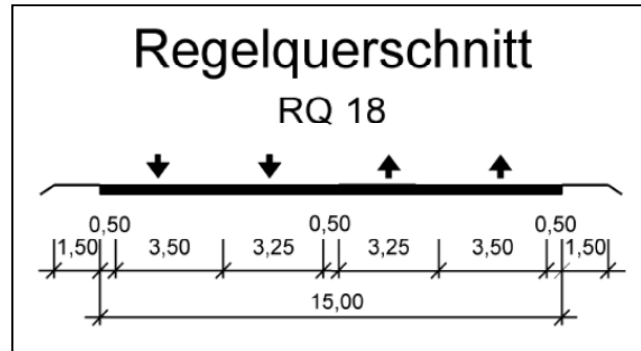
SQ 18 (STAATLICHES BAUAMT BAYREUTH)
